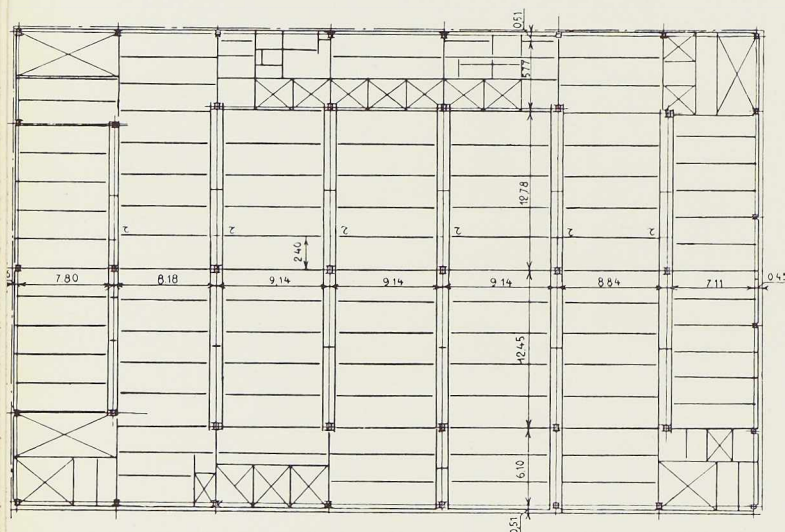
Plan d'ossature d'un étage courant du bâtiment B.
